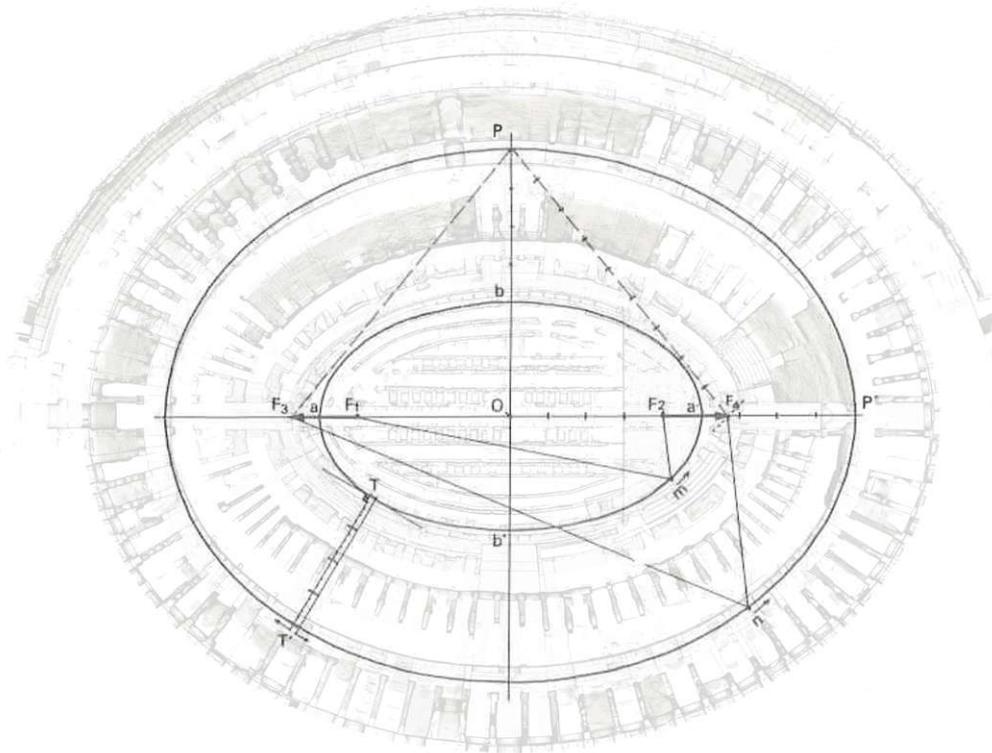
Überlagerung der „*méthode du jardinier*“ und dem tatsächlichen Grundriss des Kolosseums
